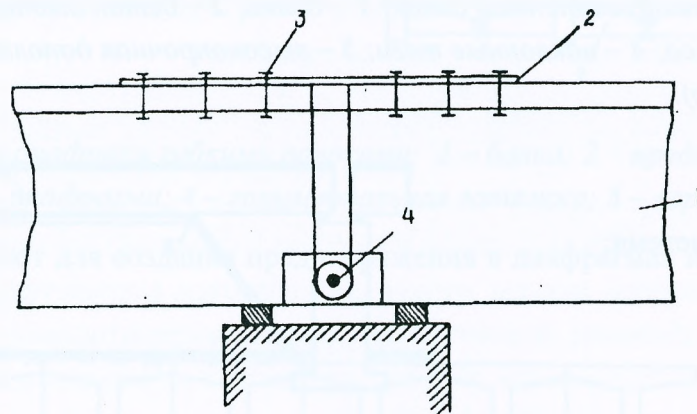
Объединение балок дополнительной листовой арматурой: 1 – балка; 2 – стальной лист; 3 – болты; 4 – клин.
